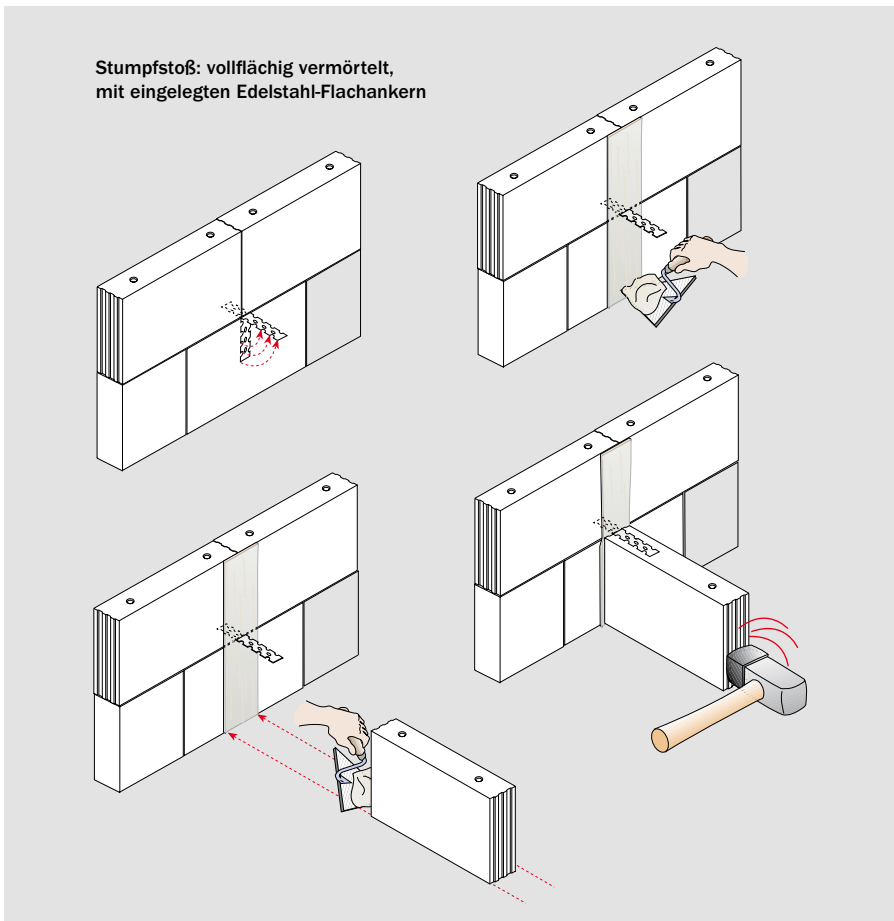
Fachgerechte Ausführung des Stumpfstoßes mit Normalmauer- oder Dünnbettmörtel
